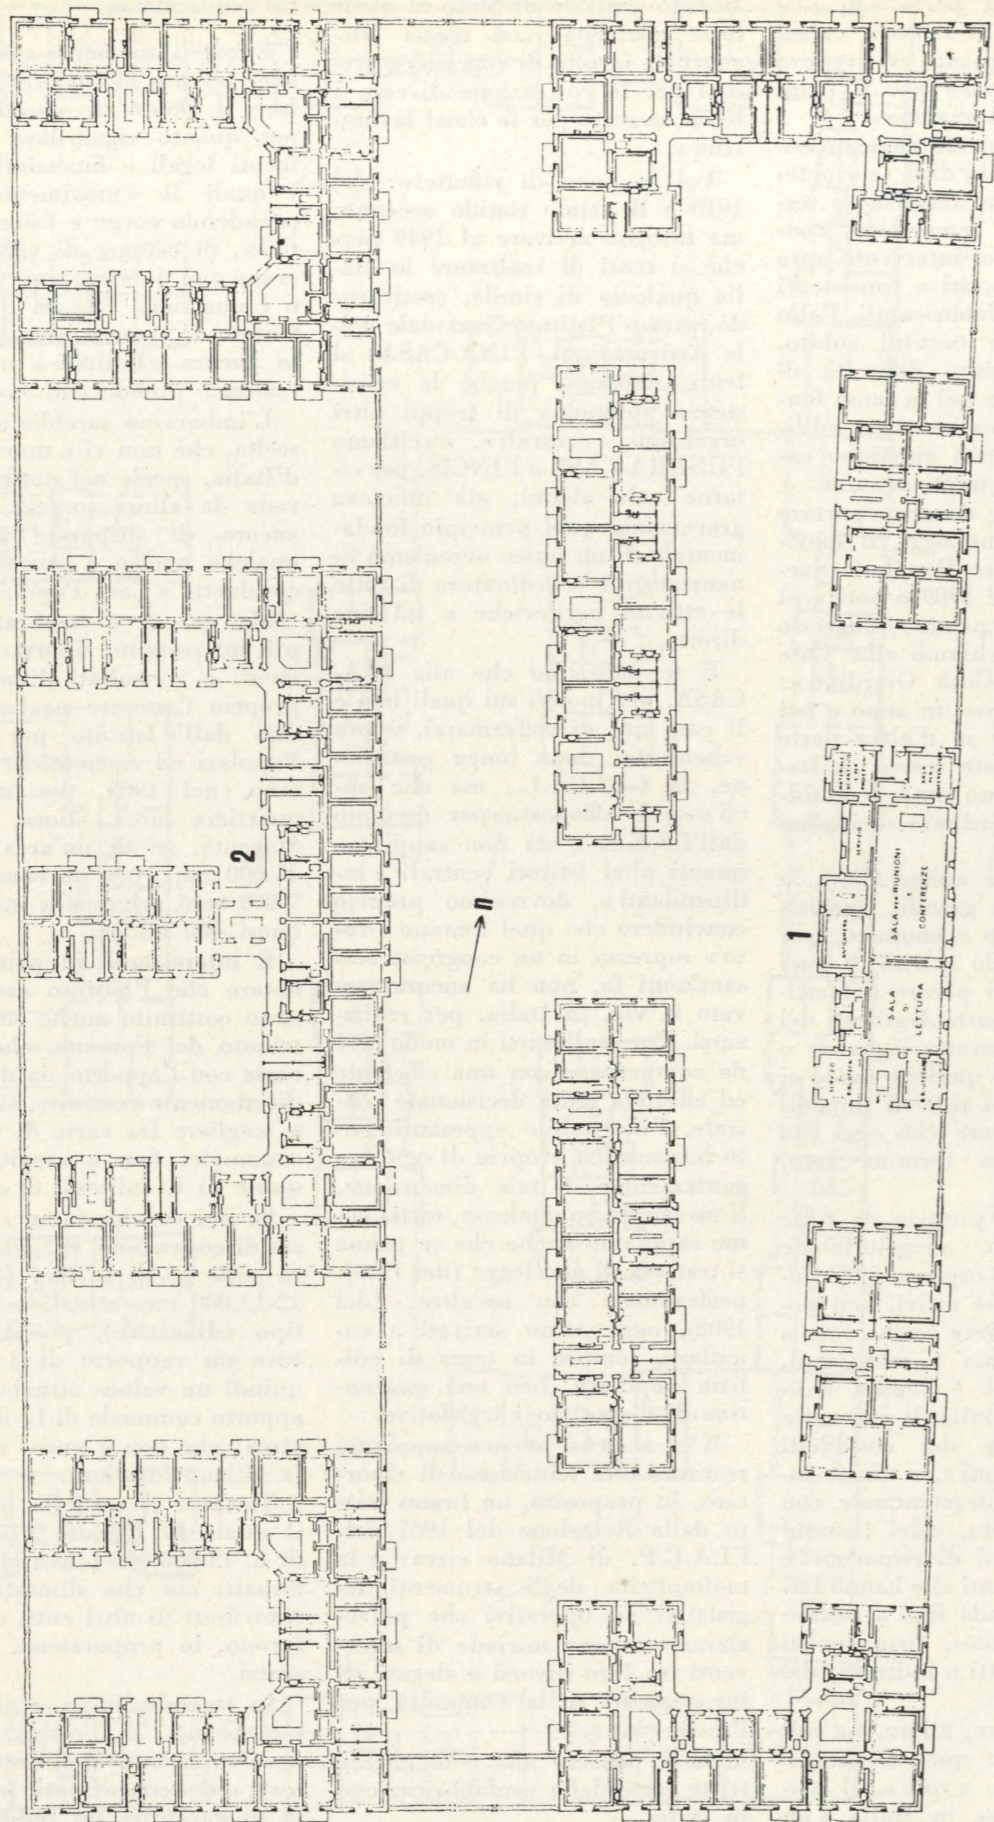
Progetto 2° classificato: la planimetria generale, con indicazione delle piante del piano tipo. 1: edificio servizi generali — 2: edificio con al p.t., l'asilo
